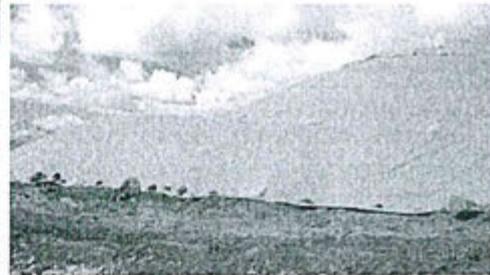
Vista panorámica 3 del Depósito de Stock Pile Top Soil recubierto con membrana plástica
